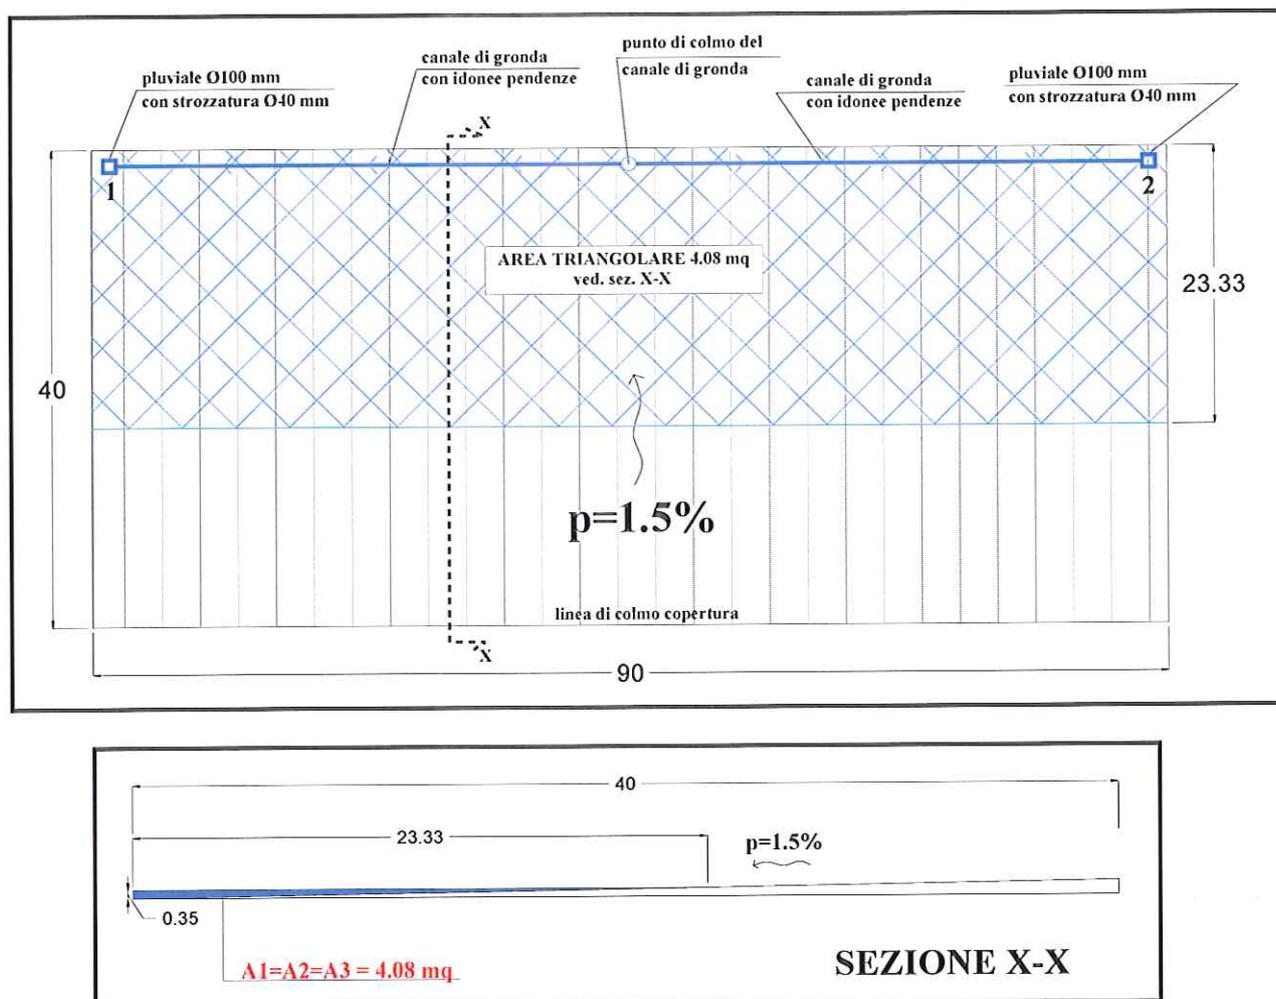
Pianta e sezione trasversale X-X della copertura edifici (celle) n°1/2/3
